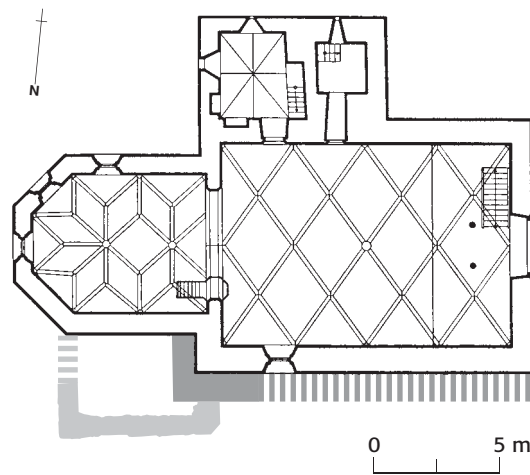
Sta. Maria V. M., evangelische Kirche, Sanierung Friedhof. Grundriss der Kirche von 1492 mit den Mauerbefunden. Dunkelgrau: vermutliche Vorgängerkirche; Hellgrau: Anbau. Mst. 1:300.
